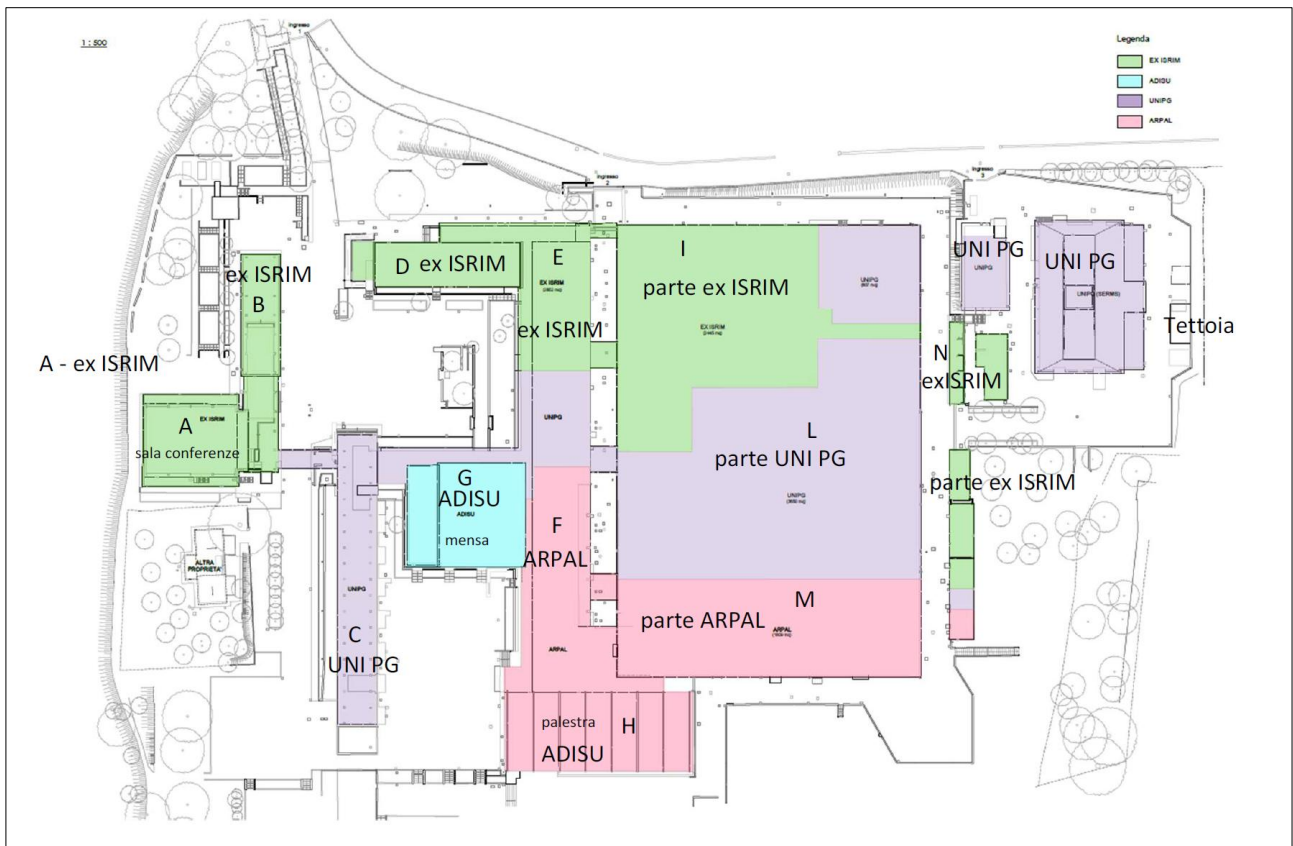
Masterplan, Planimetria generale aree fabbricate
